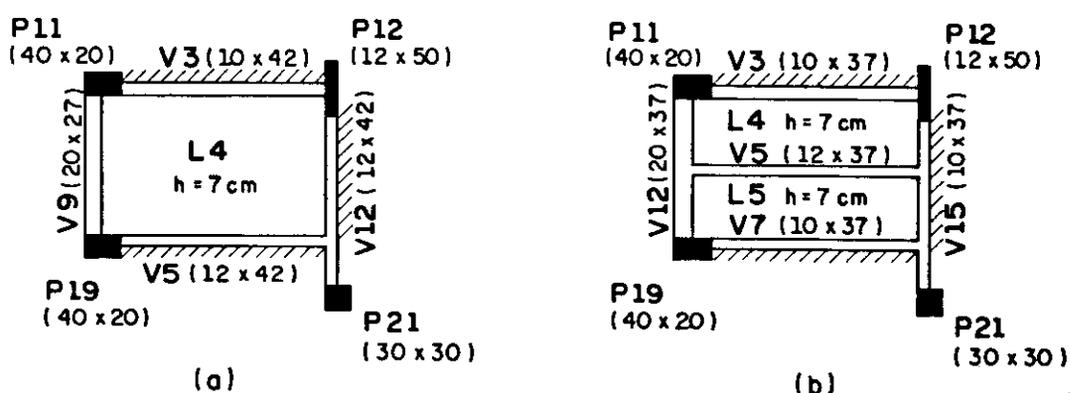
Painéis para o Estudo da Viabilidade da Divisão das Lajes L4 da ESTRUTURA III
